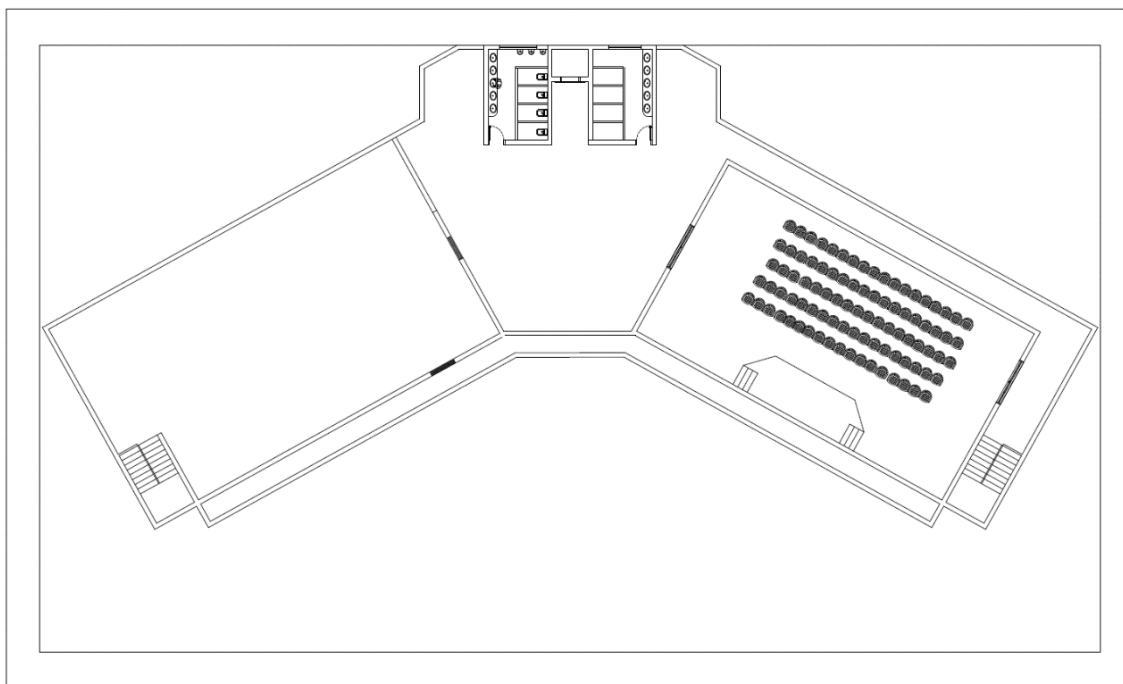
Planta baixa fornecida em 2D do primeiro e segundo pavimentos.
